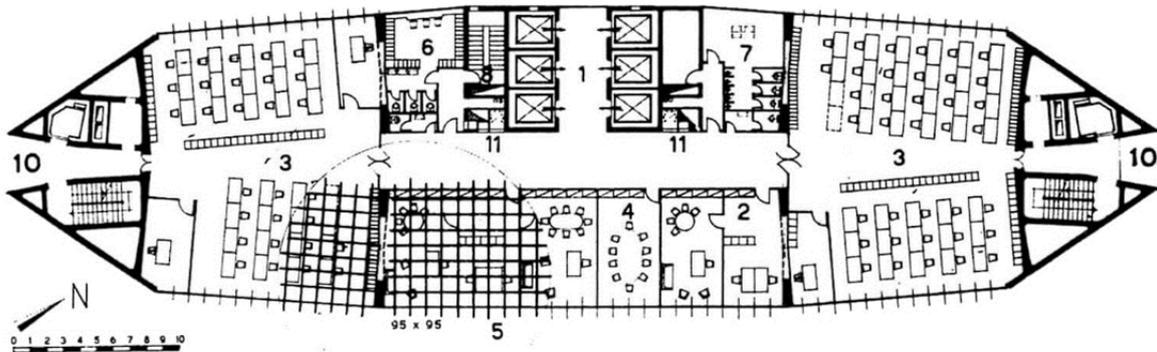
Planta da Torre Pirelli (1958) – Gio Ponti
